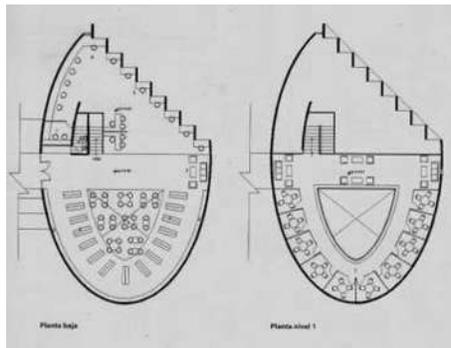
Planta de la Biblioteca Universidad Marista tomada por Roberto Cárdenas Cabello.
